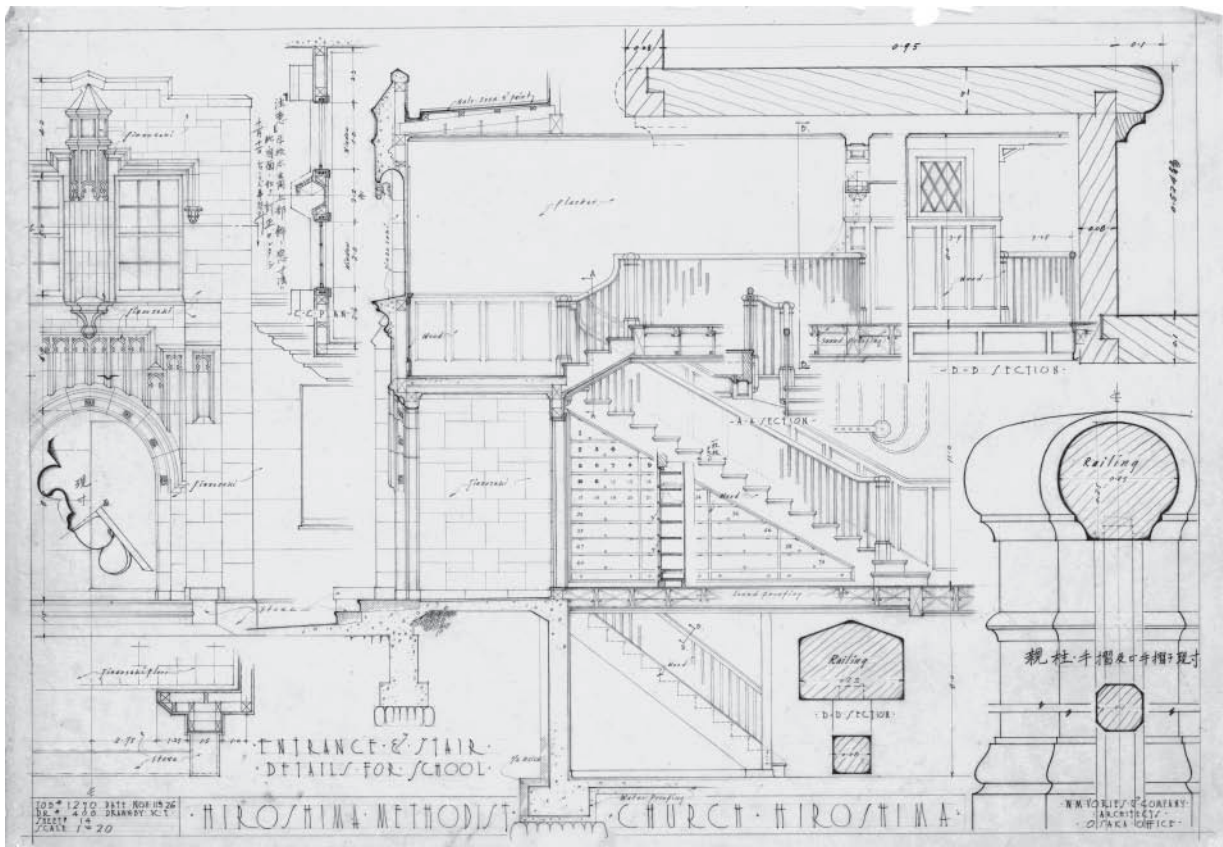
ENTRANCE AND STAIR DETAILS FOR SCHOOL (日曜学校玄関および階段部詳細図)
